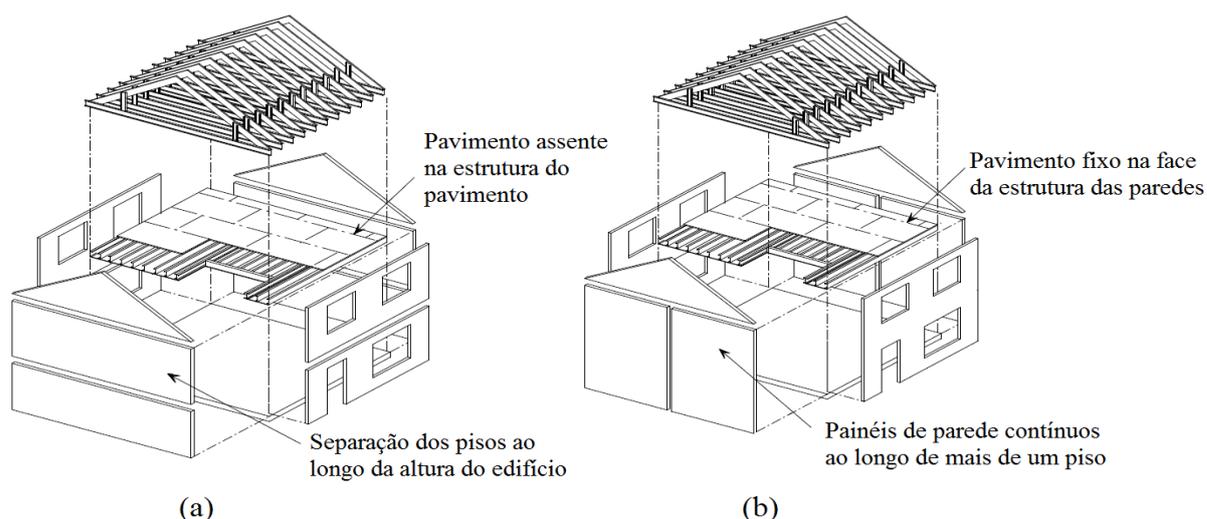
Pormenores construtivos de construção por perfis em LSF: (a) “*Platform Framing*”; (b) “*Balloon Framing*” (Grubb *et al.*, 2001)
